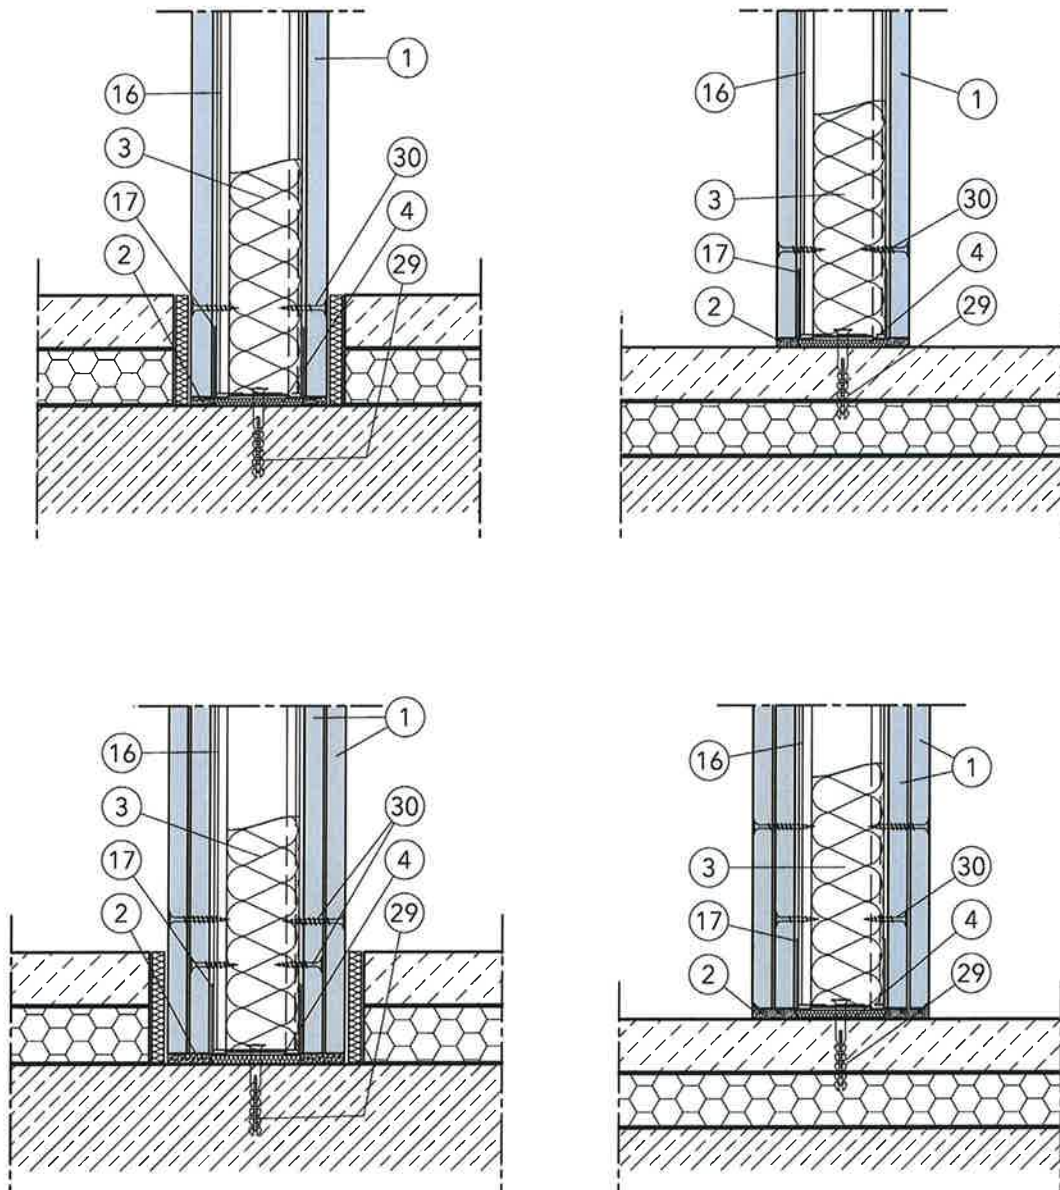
Starrer Bodenanschluss mit schwimmendem Estrich (einlagige u. zweilagige Bekleidung)
